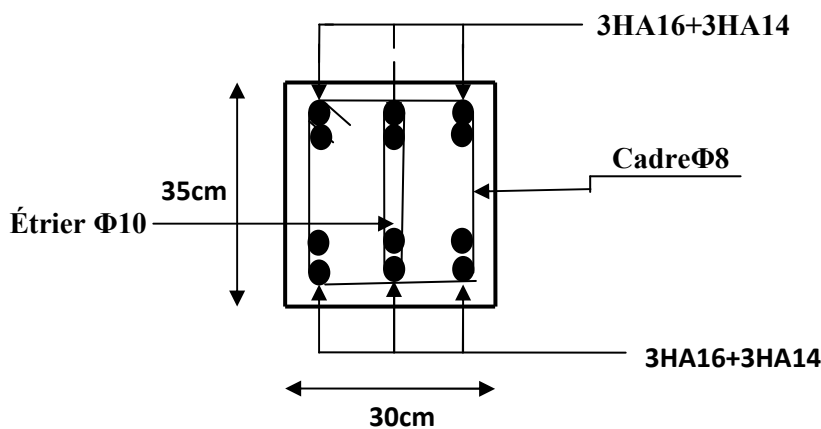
Ferrailage de la Poutre palière (travée et appui)
